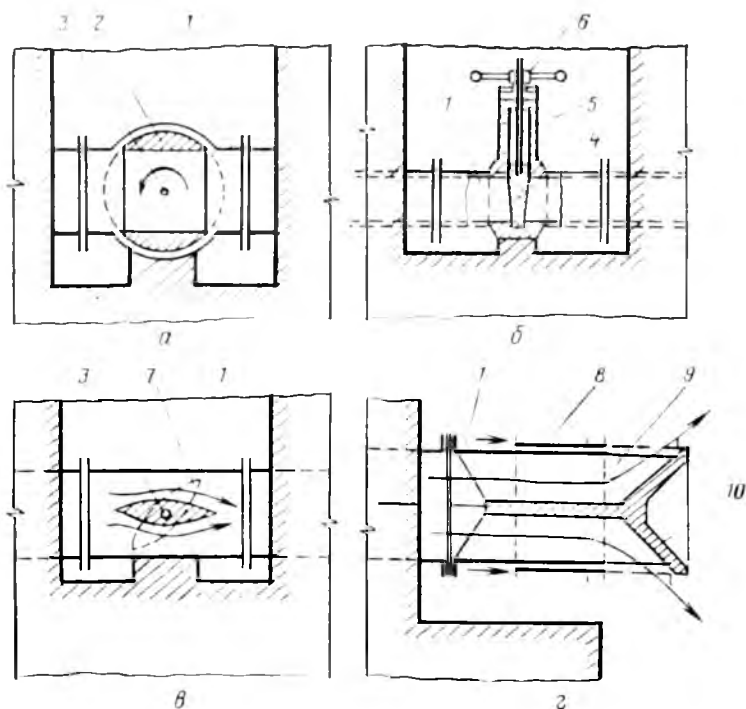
Схемы затворов трубопроводов с самонесущим корпусом:
